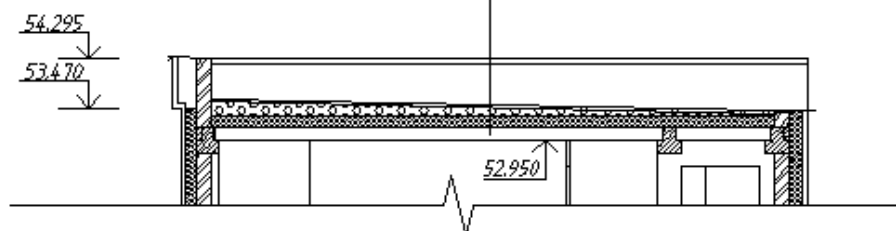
Конструкция покрытия над техническим этажом
